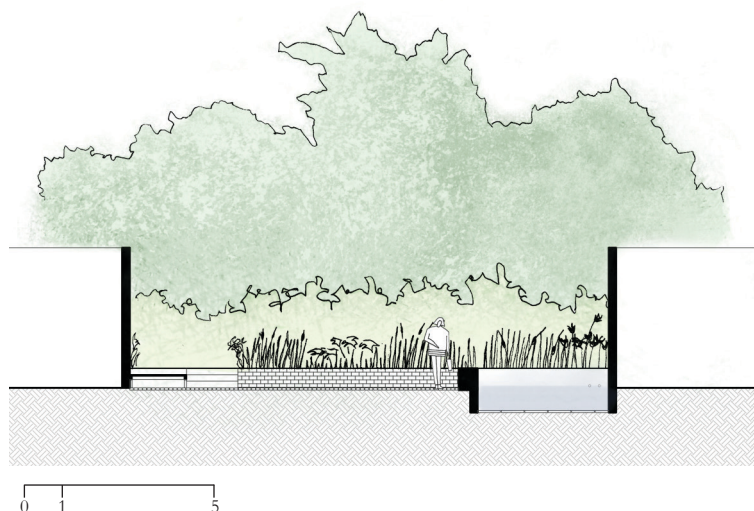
vista da entrada do parque. Corte transversal na Travessa da Fonte.
